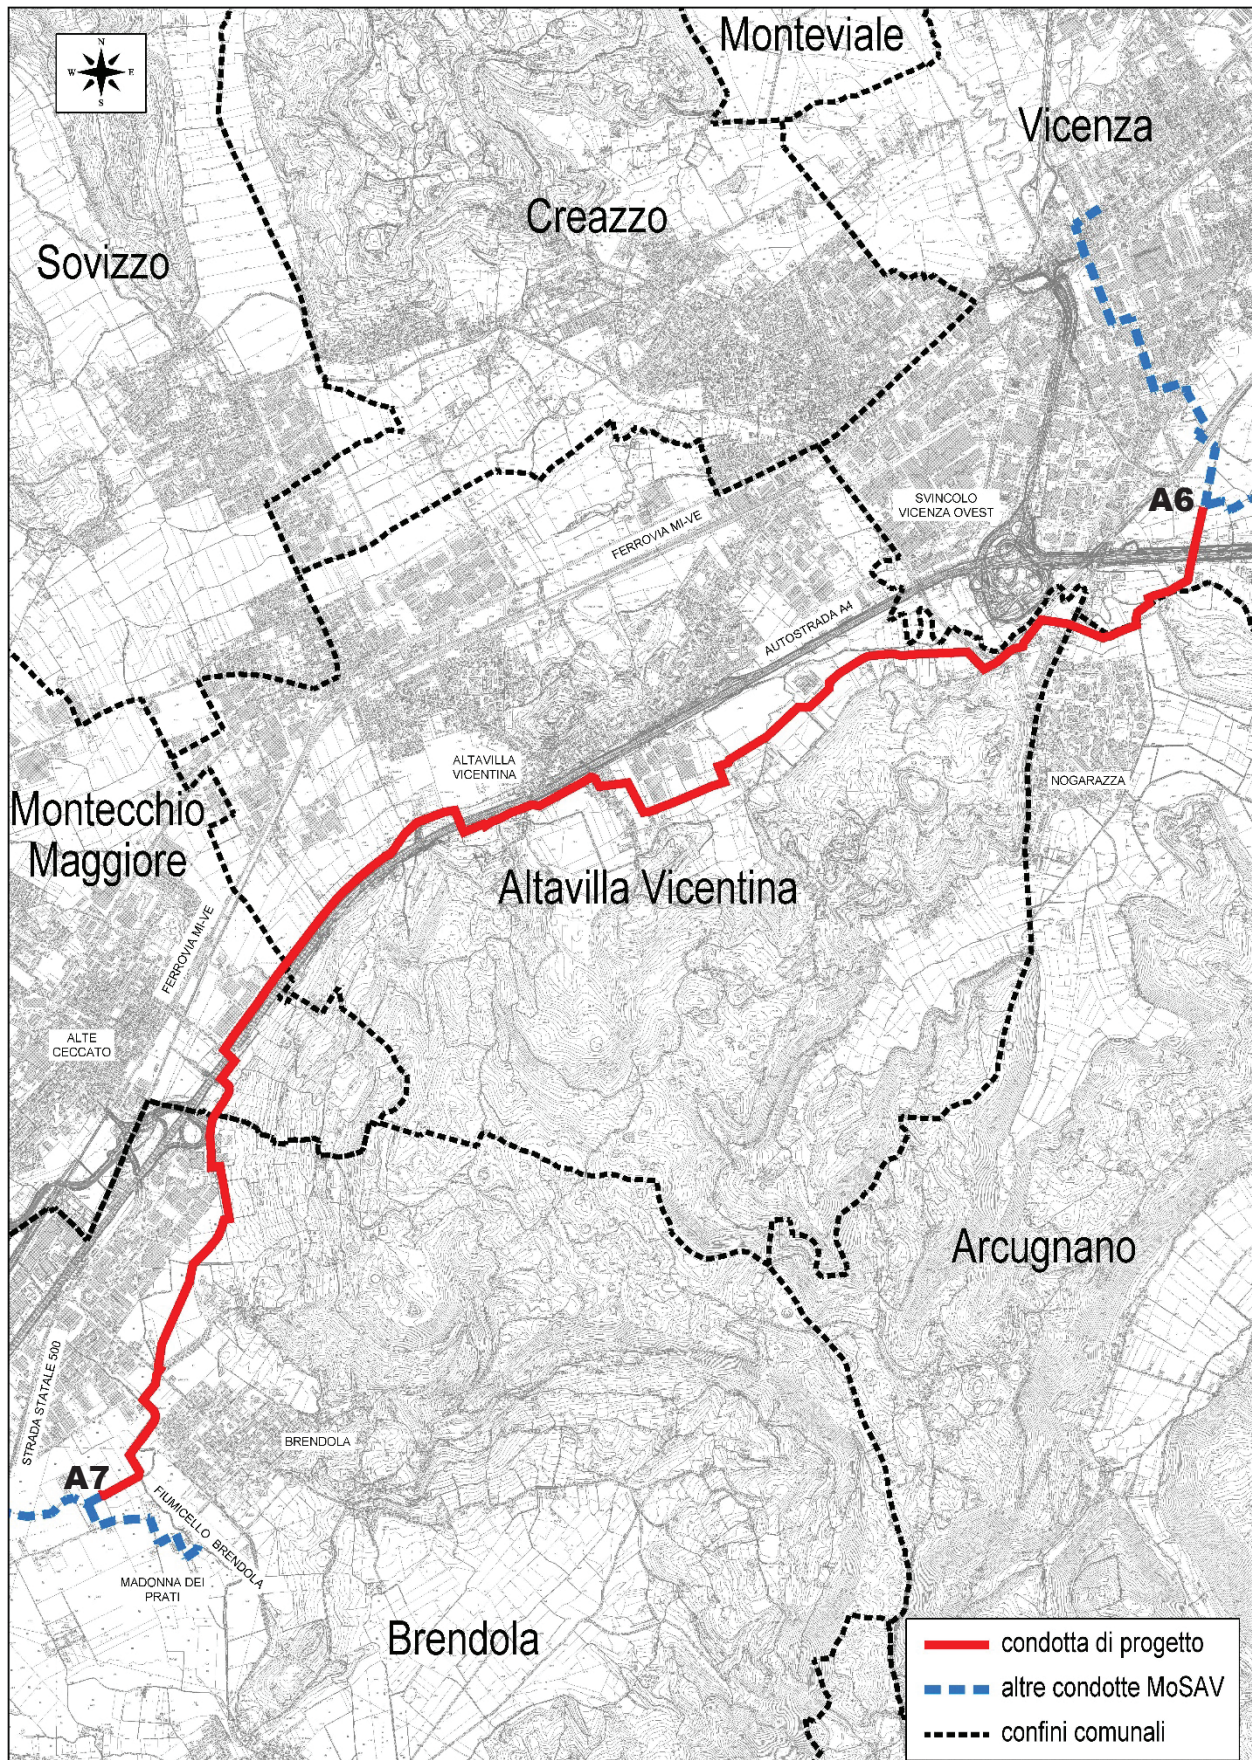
Planimetria generale del tracciato della condotta di progetto.
